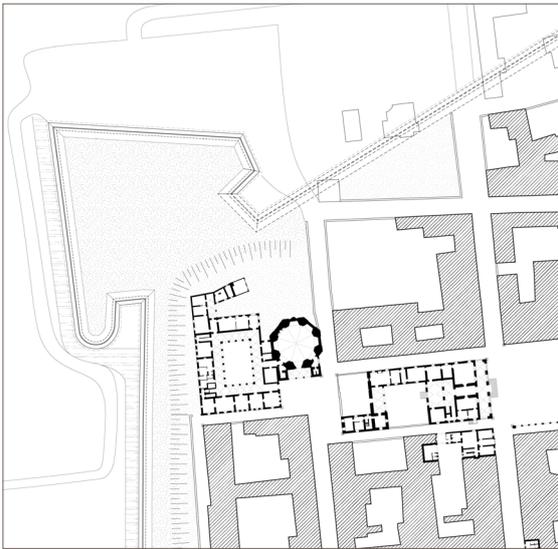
Stadtgrundriss Bestand, nördlicher Bereich (Ausschnitt). Zeichnung: Forschungsstelle Baugeschichte und Denkmalpflege, RWTH Aachen University, Prof. Dr. Jan Pieper.
